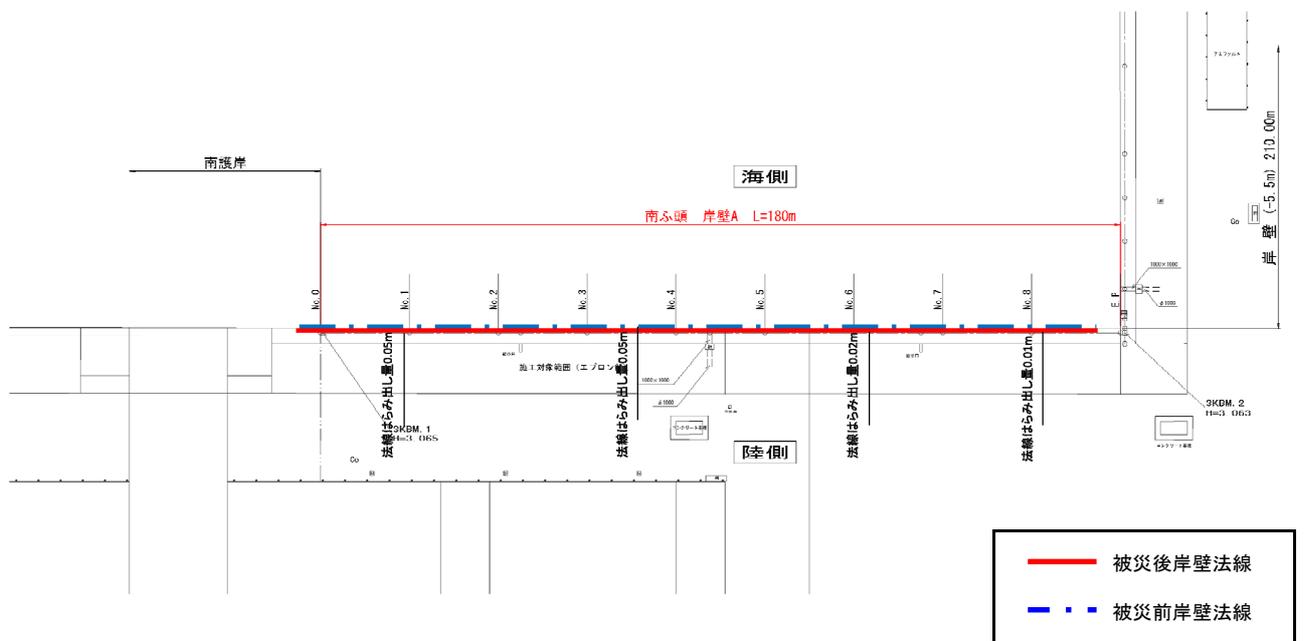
241 No.21 常陸那珂港区_南ふ頭地区 A 岸壁 (-5.5m) の平面図 (被災後)
